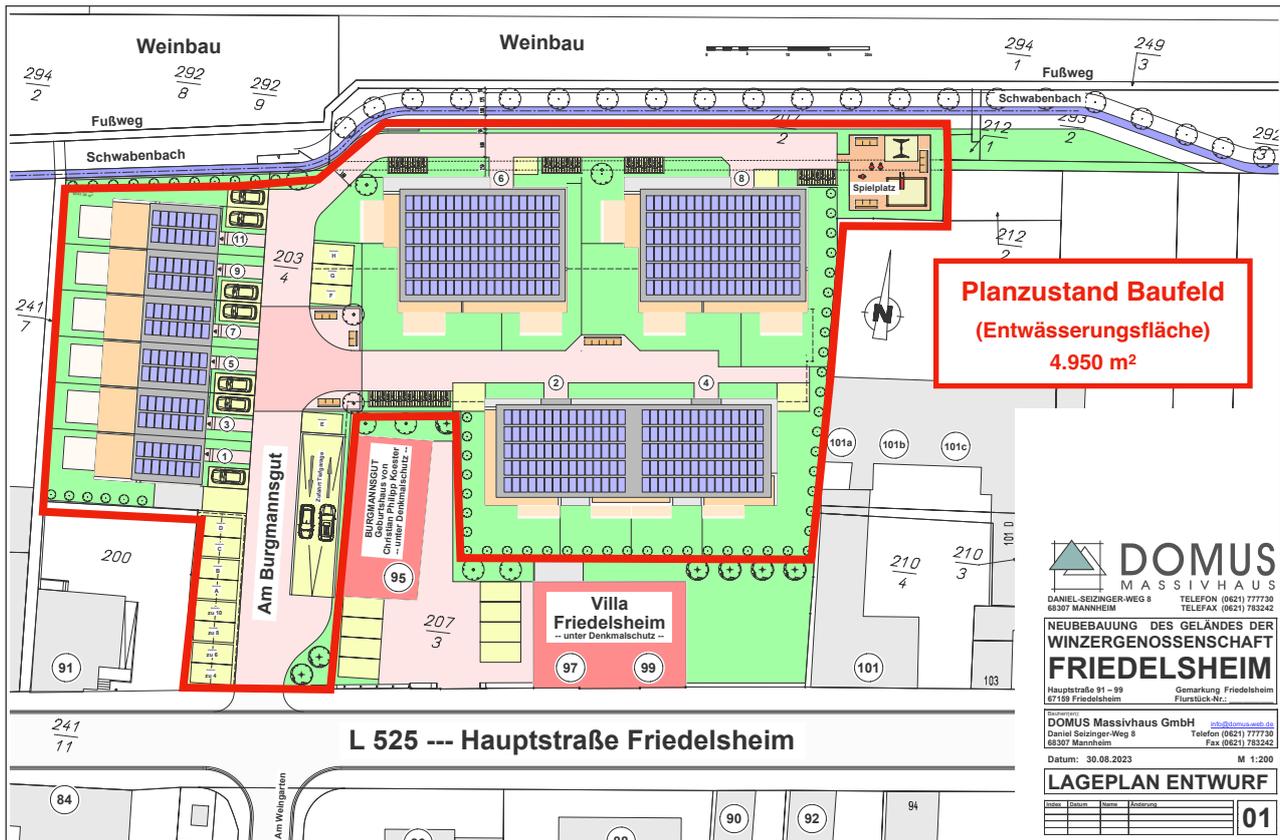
Lageplan Entwurf - Baufeld (Bild Quelle: Domus Massivhaus GmbH)
